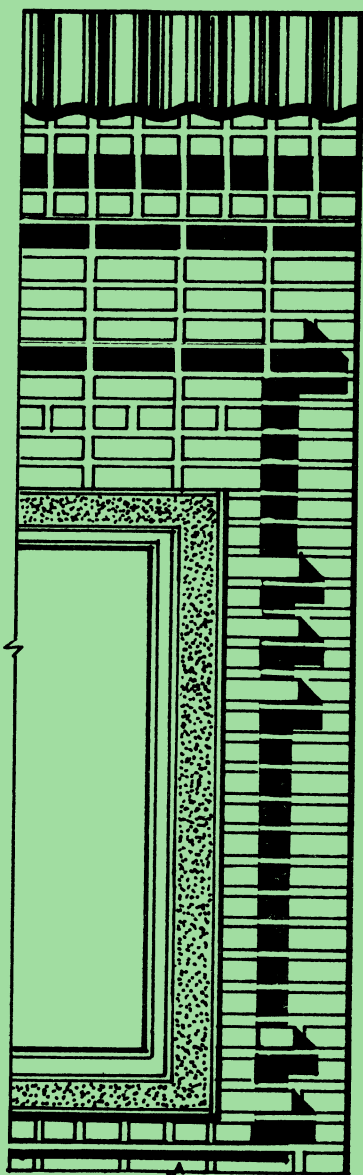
Разрез шлакобетонной стены из сборных блоков:
